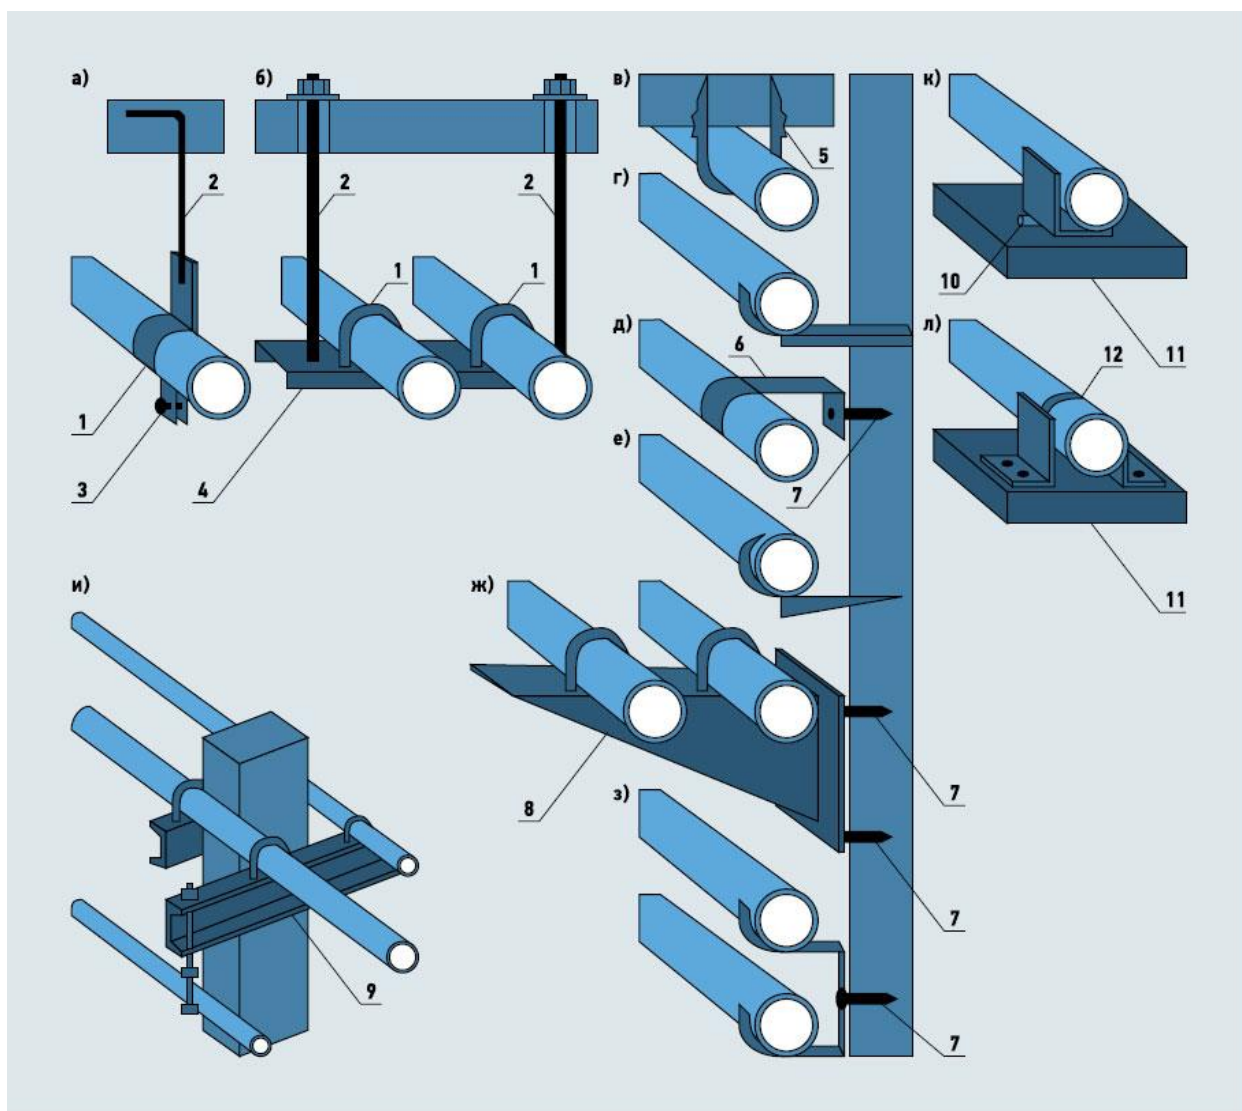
расположения трубопроводов (а — на подвеске; б — на подвеске с опорной балкой; в — скобой; г — на кронштейне; д — хомутом; е — крючком; ж — на кронштейне с подкосом; з — приварной скобой; и — на колоннах; к — на подвижной опоре; л — на неподвижной опоре; 1, 6 — хомуты; 2 — тяга; 3 — болт; 4 — балка; 5 — скоба; 7 — дюбель; 8 — подкос; 9 — швеллер; 10 — каток; 11 — основание; 12 — сварка с использованием различного вида креплений).
